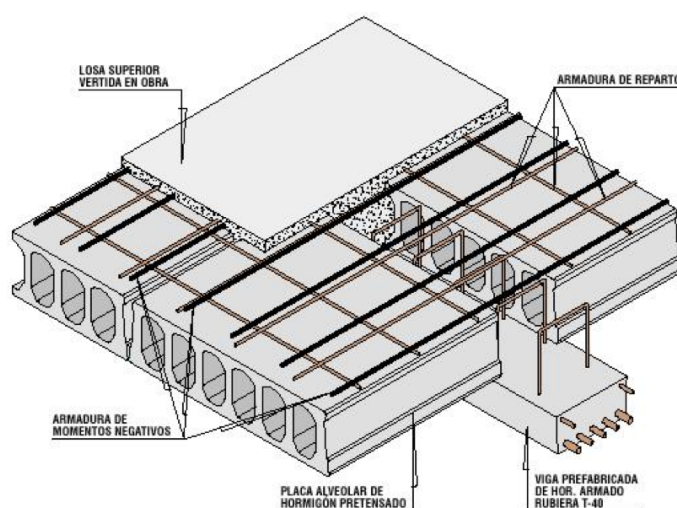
Forjado mediante losas alveolares. Imagen: Rubiera Predisa
